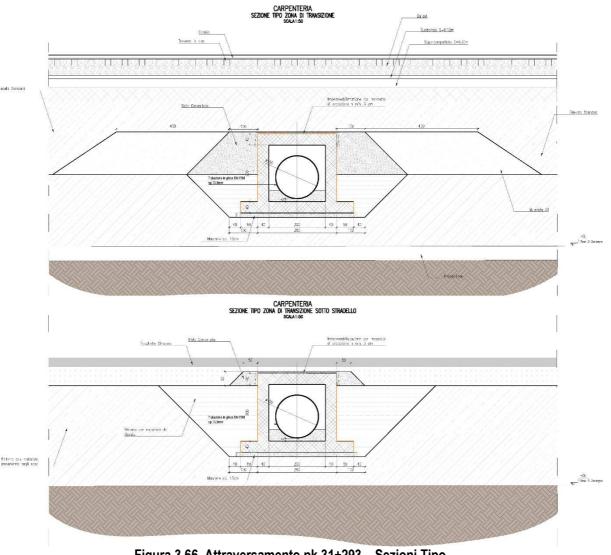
Attraversamento pk 31+293 - Sezioni Tipo
